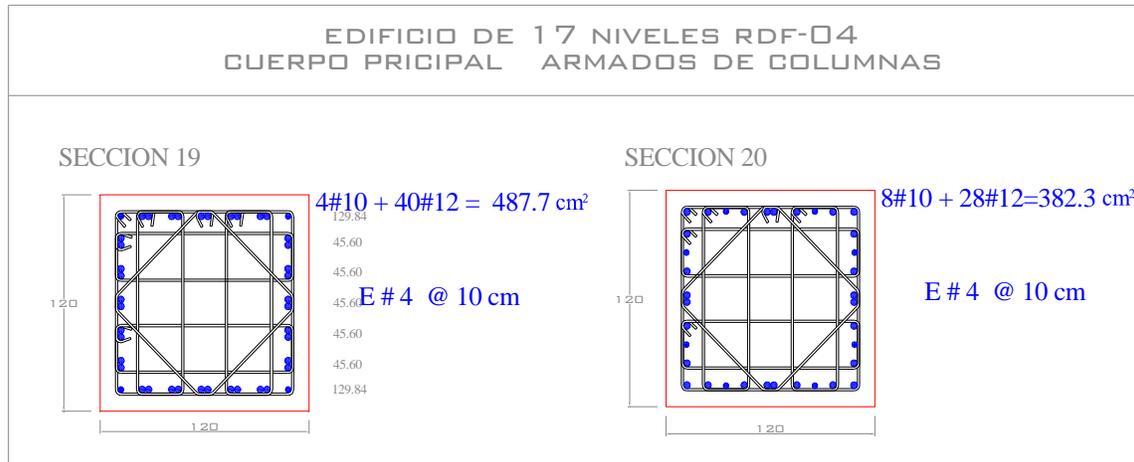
Armados de acero longitudinal y transversal propuestos en columnas, edificio 17 niveles, Cuerpo Principal (caso A) de las NTC-Sismo, RDF-04
